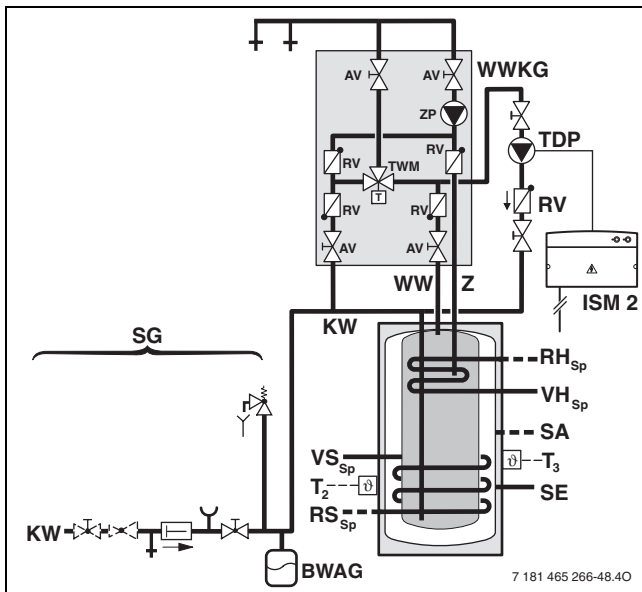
Схема контура ГВС с поддержкой отопления от солнечного коллектора, с термической дезинфекцией и группой комфортного режима WWKG для ГВС
